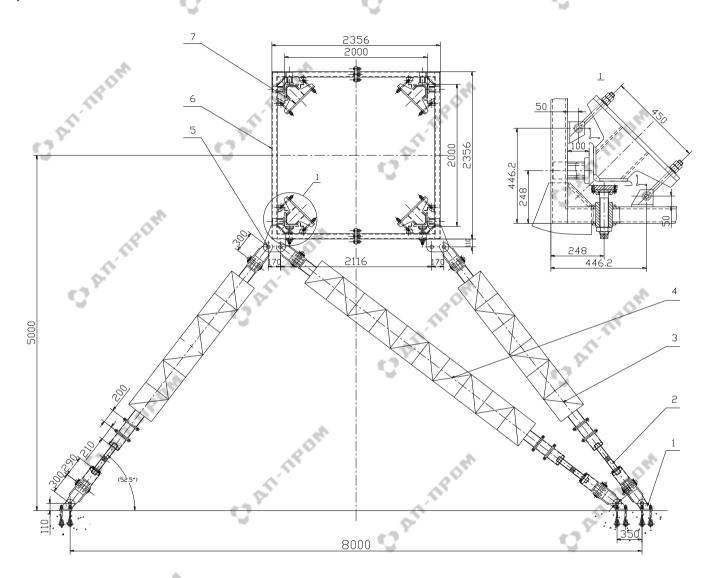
Монтаж настенной опоры 1.седло болта; 2.винт; 3.раскос; 4.длинный раскос; 5.палец; 6. пояс; 7.балка закрепления
